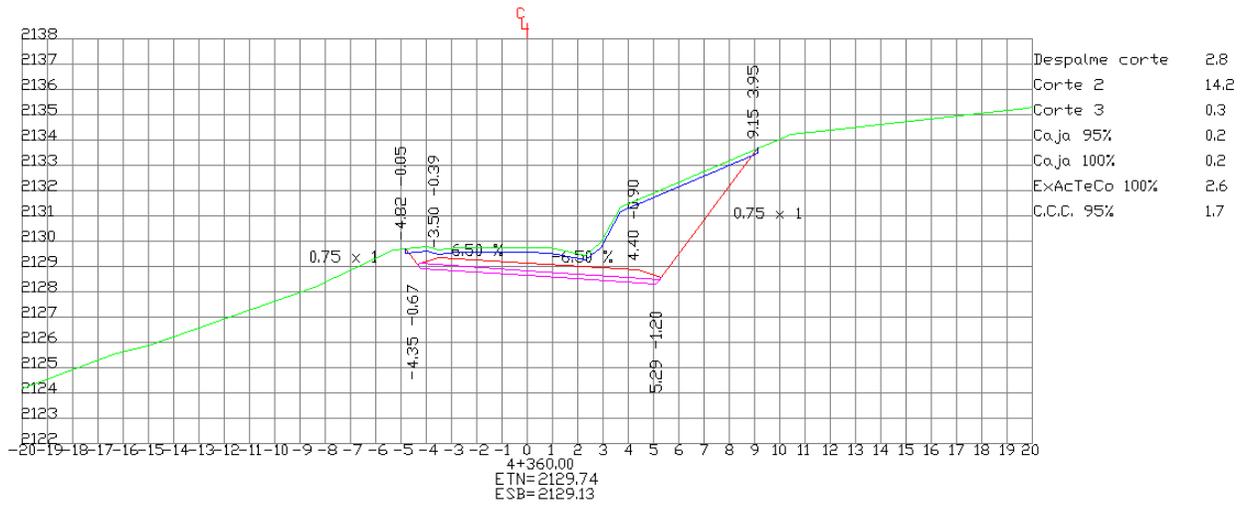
Sección transversal, km 4+360, en zona donde se requiere defensa metálica lado izquierdo.
